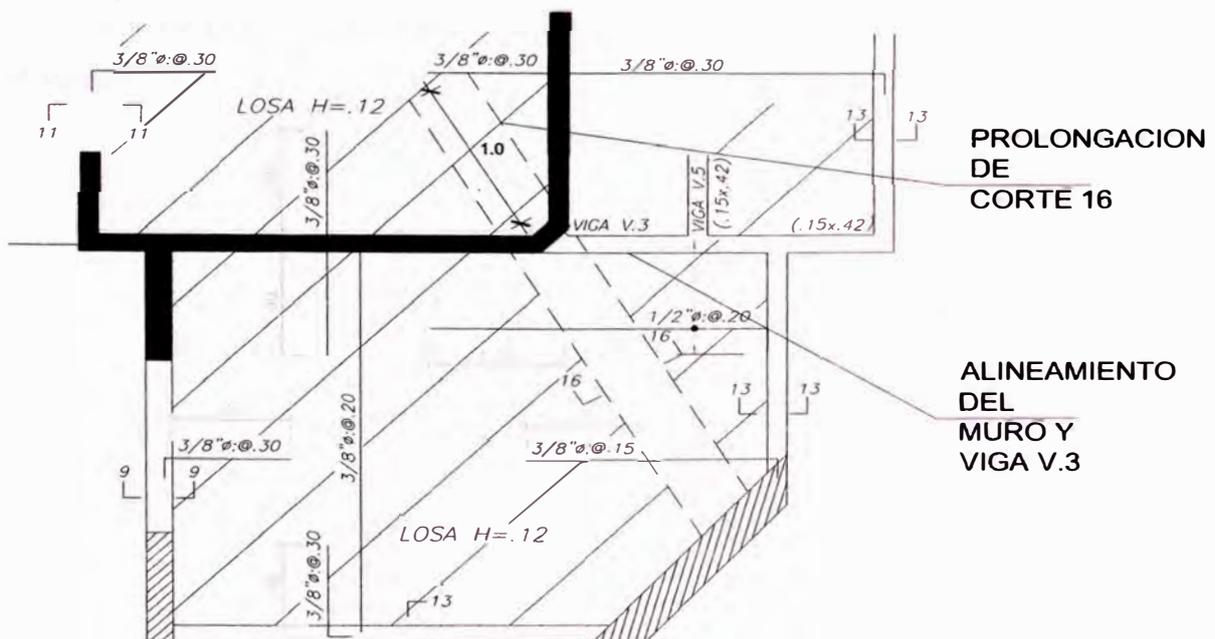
Vista en planta de la armadura del corte 16, en las losas típicas. Se hizo necesario prolongar esta viga dado que era un empotramiento. Nótese que el muro y la viga V.3 se alinearon con el muro portante. V.3 empotra en el muro con longitud adicional de 80 cm.
